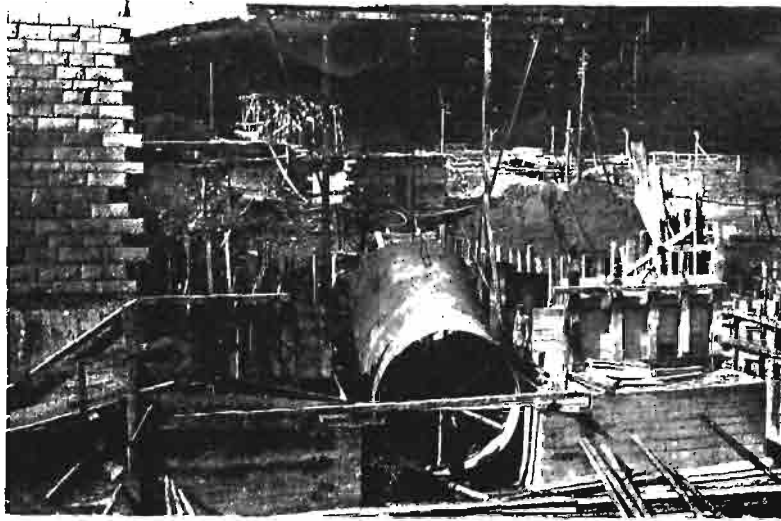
Widok na ostrogę bloku 9-ego. Widoczne rury zastrzykowe.
